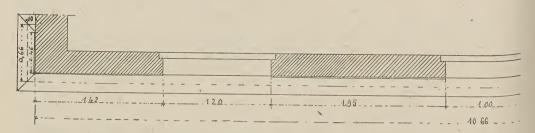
Ravalement sur pierre vieille et sur brique vieille à l'étage d'attique sur rue.
